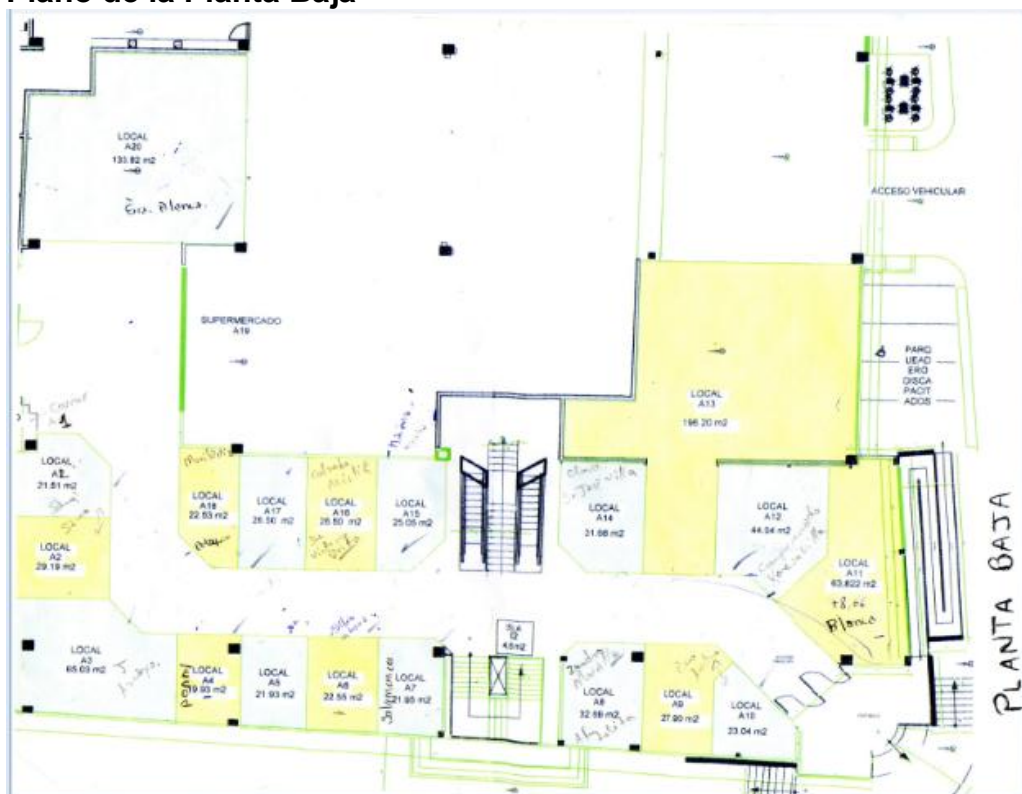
, Plano de la planta baja de MASGUAL S.A.
